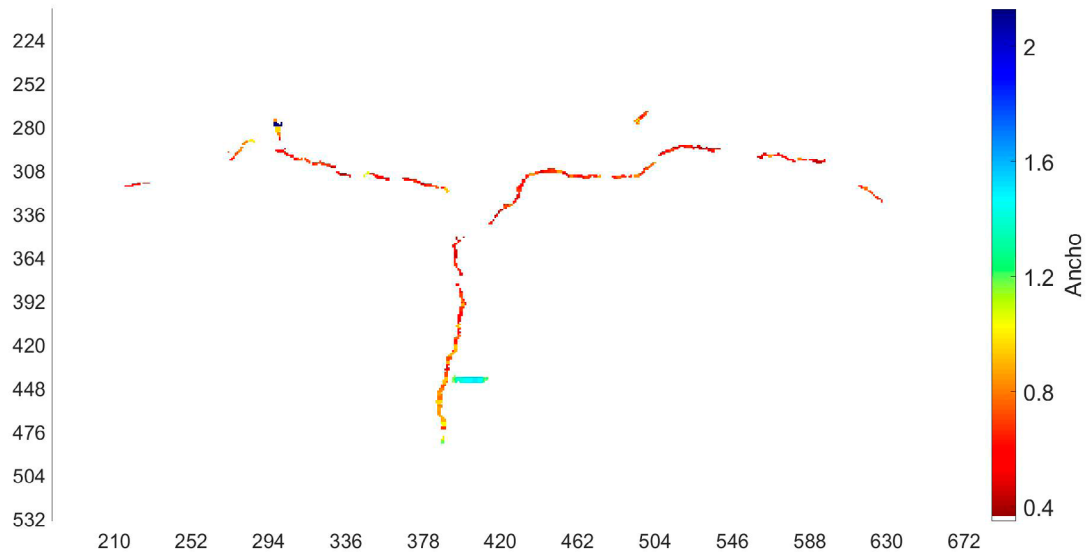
Trazado de la fisura, escala de colores para los anchos en mm.
